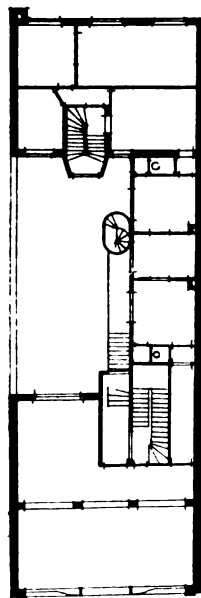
Shadowstrasse 47. Obergeschoss. 1:500.
